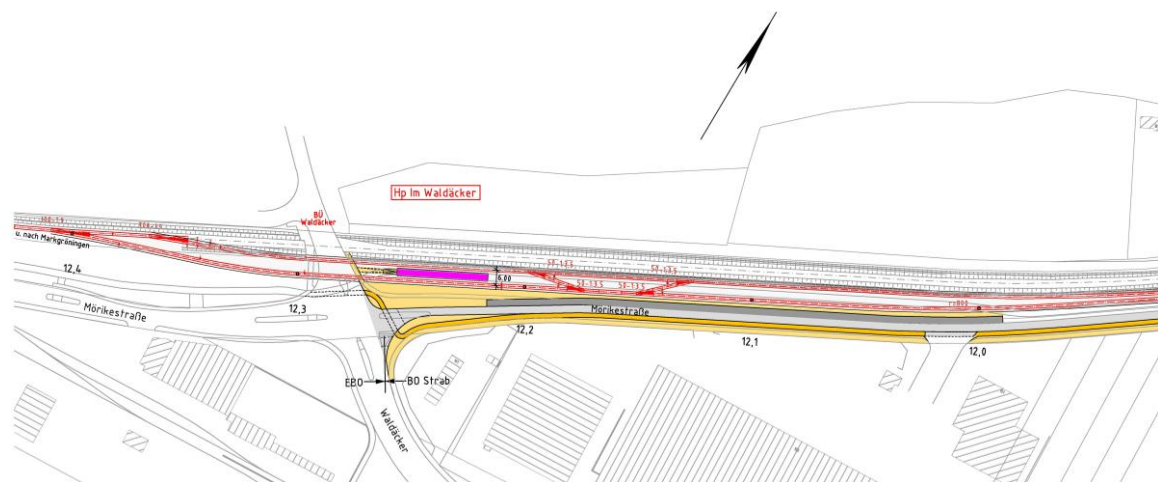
Lageplan Hp „Im Waldeck“ (Planung)
